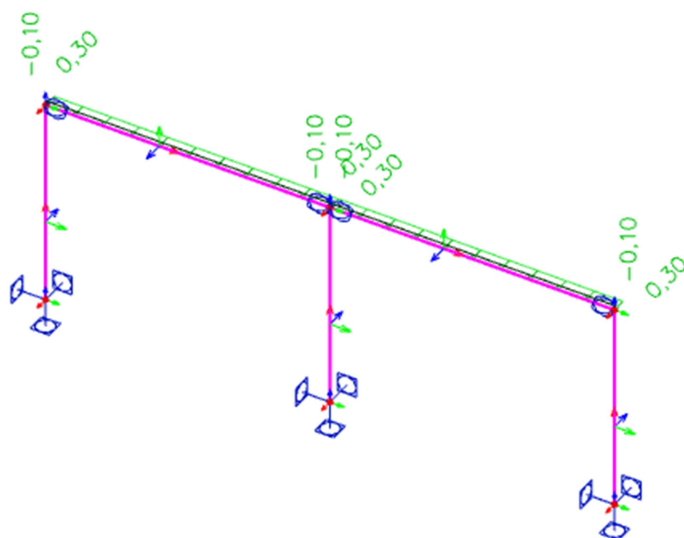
Konstrukce 1, Zatěžovací stav ZS3
